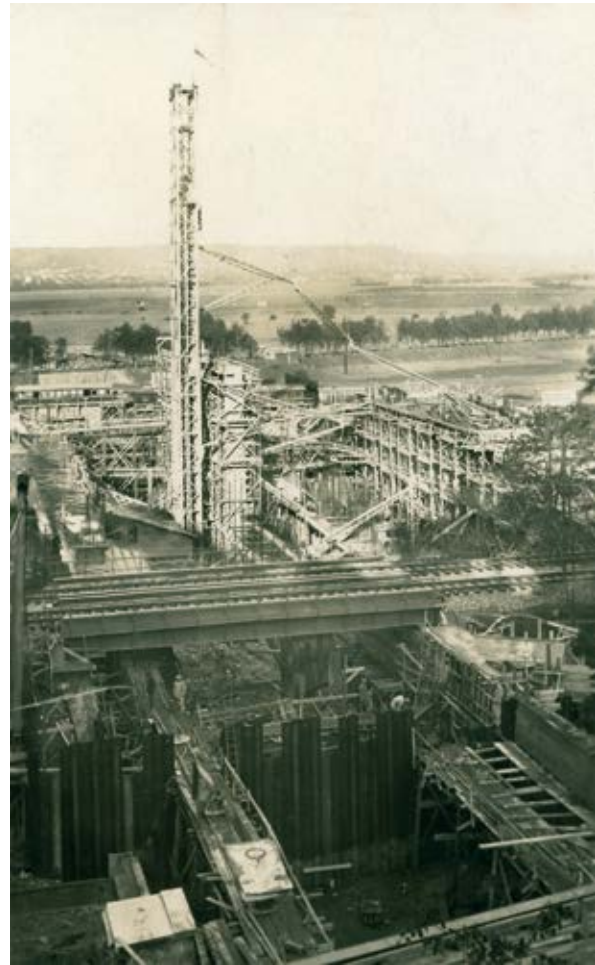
Baustelle am Unterbecken des Pumpspeicherwerks Niederwartha mit dem Gießturm zum Einbringen des Betons
